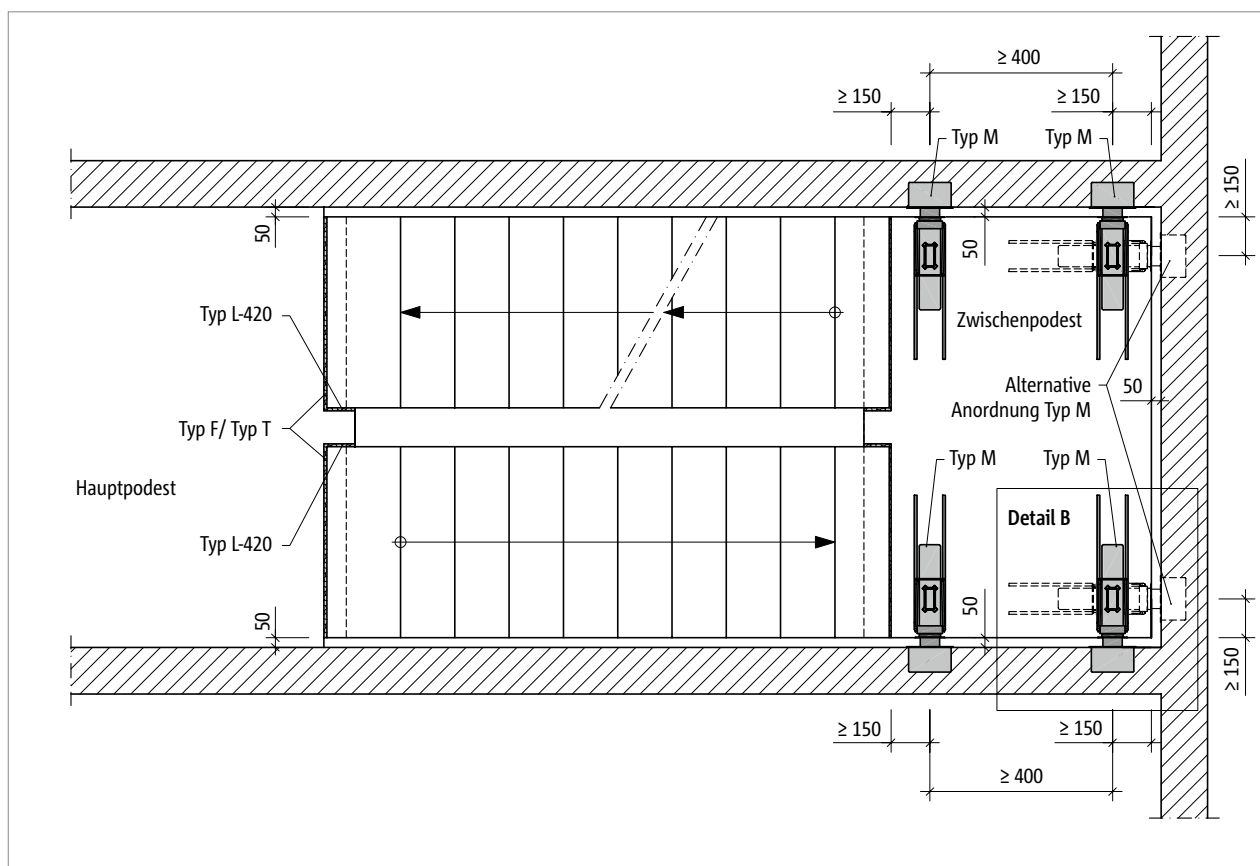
Tronsole® M: Elementanordnung im Grundriss bei einer Fugenbreite von 50 mm
